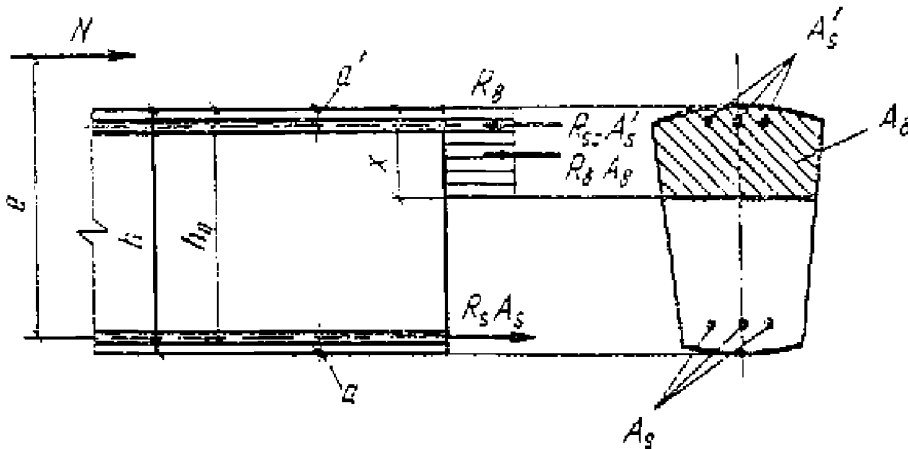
Схема усилий и эпюр напряжений в сечении, нормальном к продольной оси внецентренно сжатого железобетонного элемента, при расчете его по прочности
